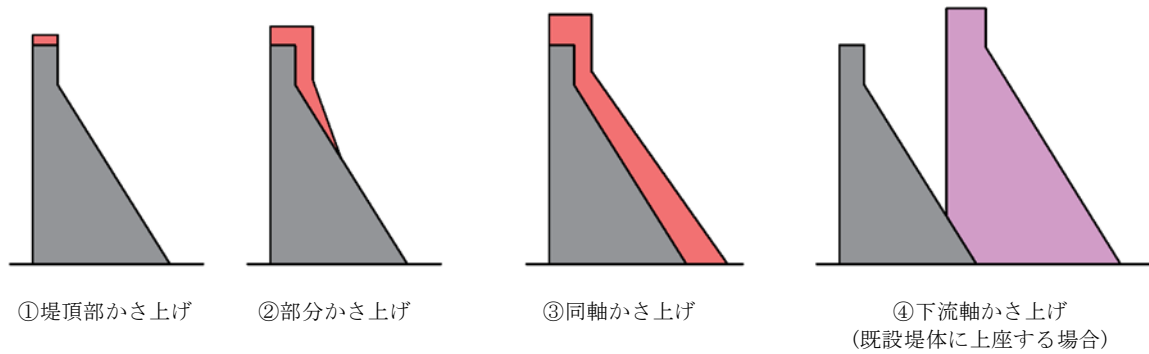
重力式コンクリートダムのかさ上げのタイプ
